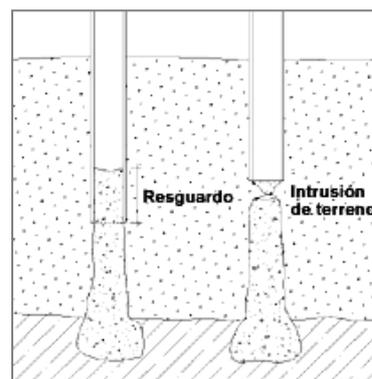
Defectos de ejecución de pilotes hormigonados in situ: Intrusión de terreno por defectuosa extracción de la entubación
